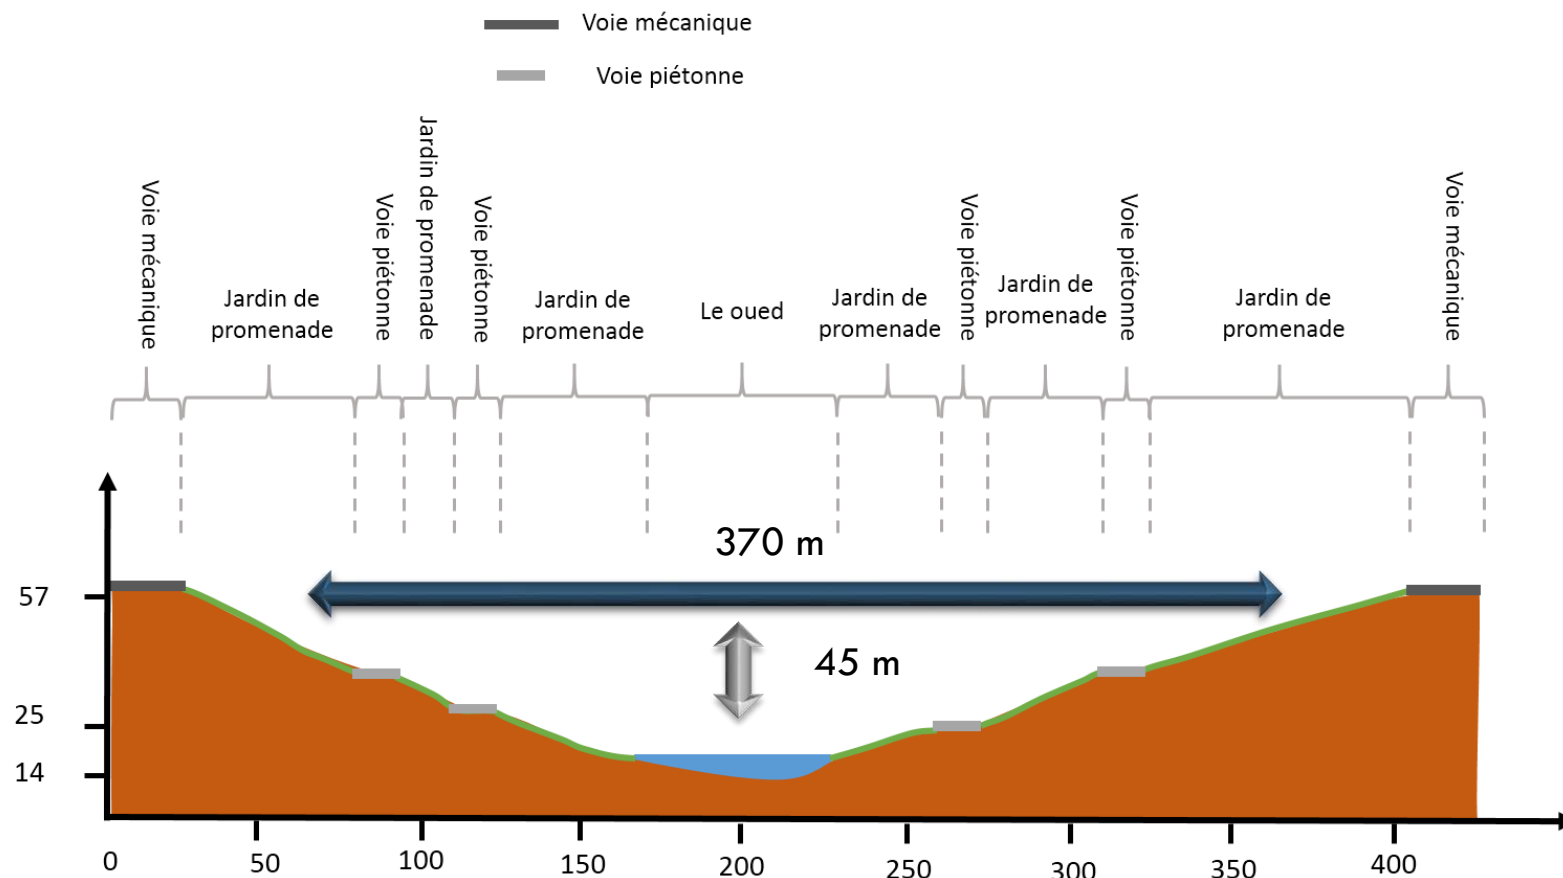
coupe transversale (A-A) du lieu d'intervention
